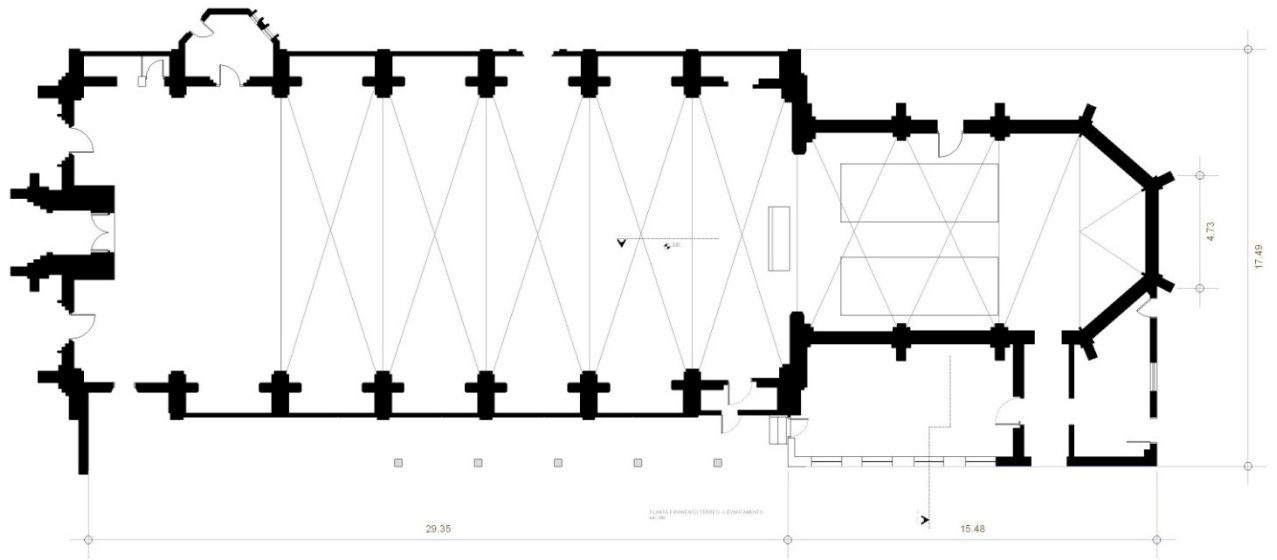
e: Igreja do Senhor Bom Jesus dos Perdões – croqui: planta da nave e presbitério.
